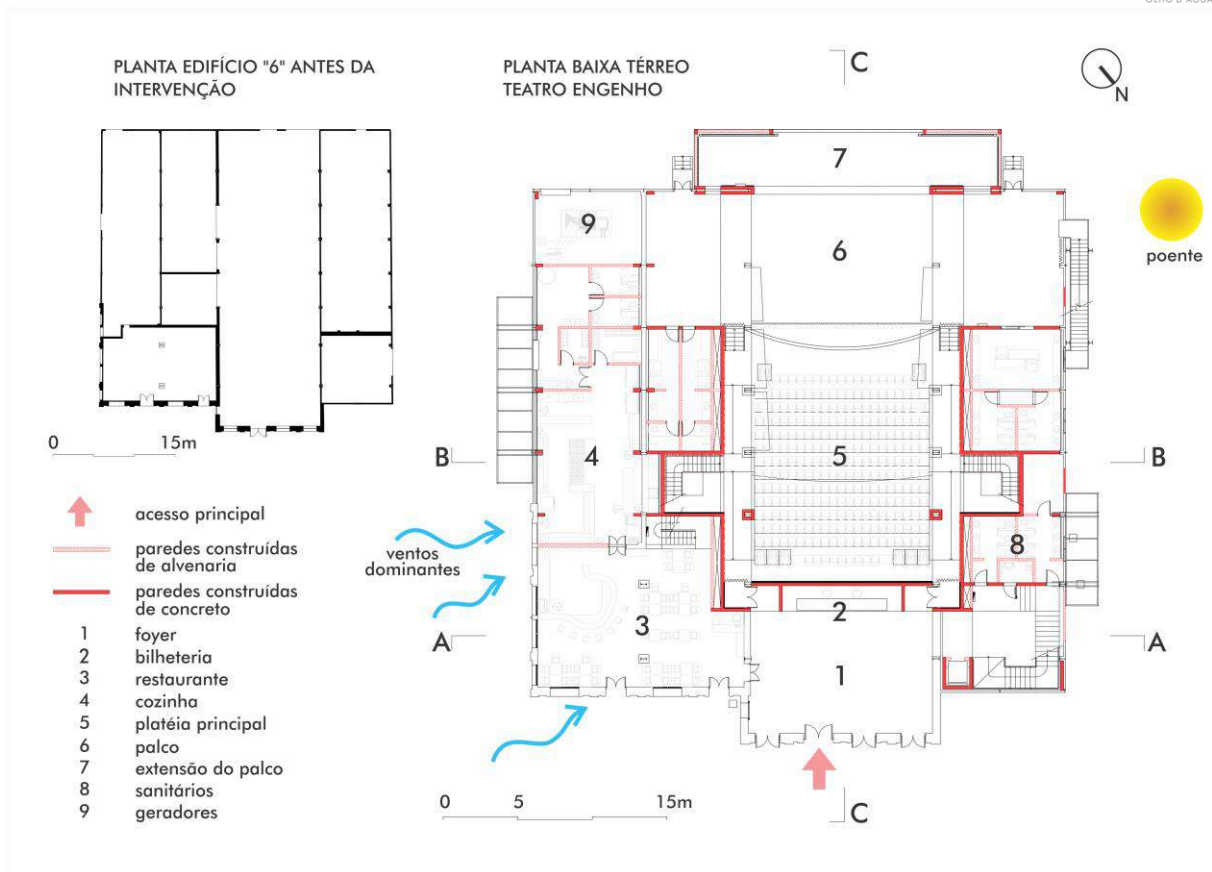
Planta baixa andar térreo Teatro Engenho.
